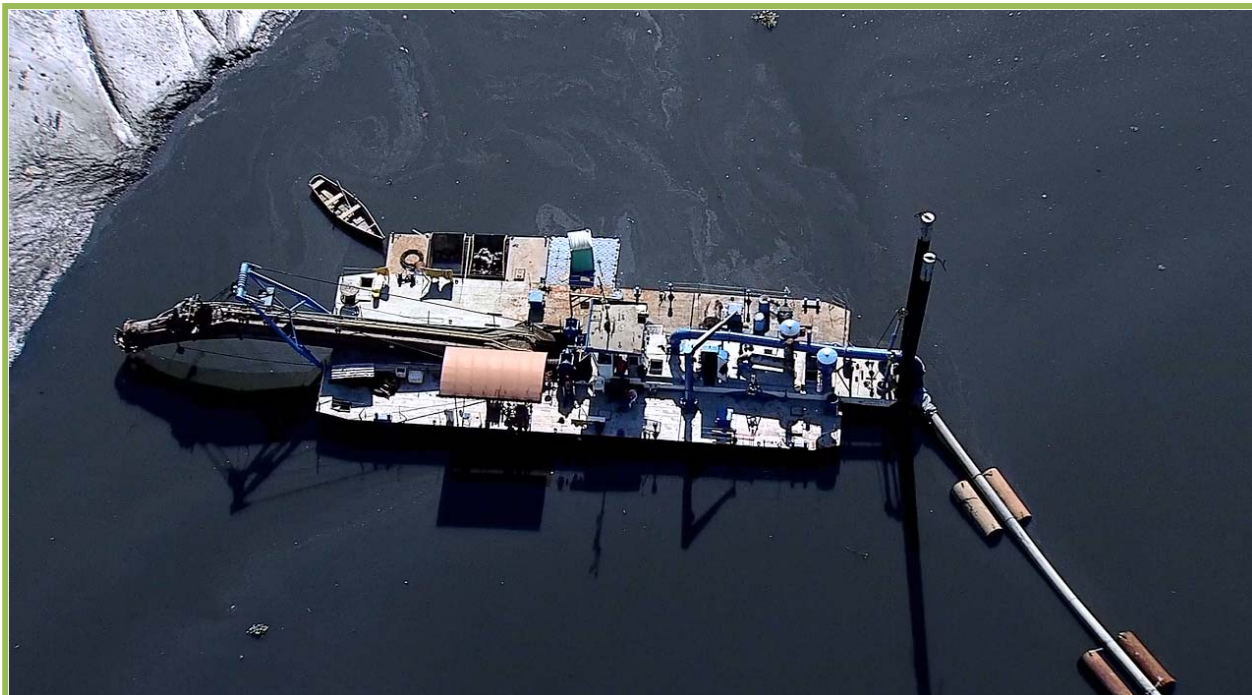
Exemplo de equipamento a ser utilizado.
